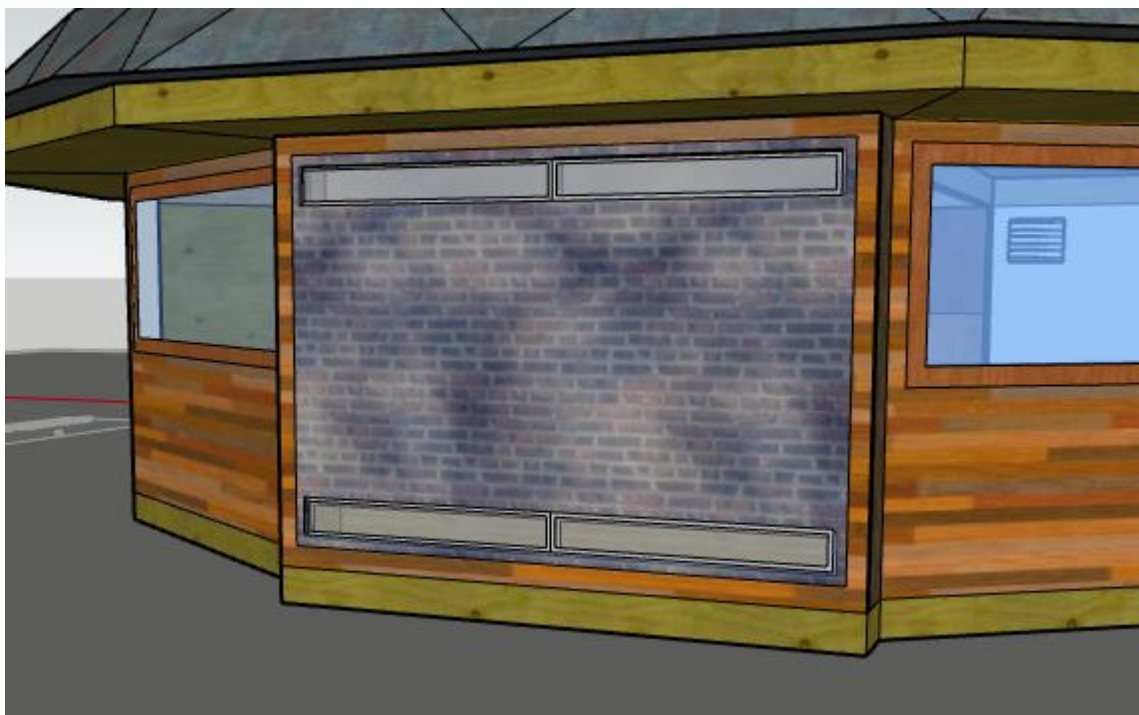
Muro trombe y Protección Fachadas en vivienda (Elaboración propia)
